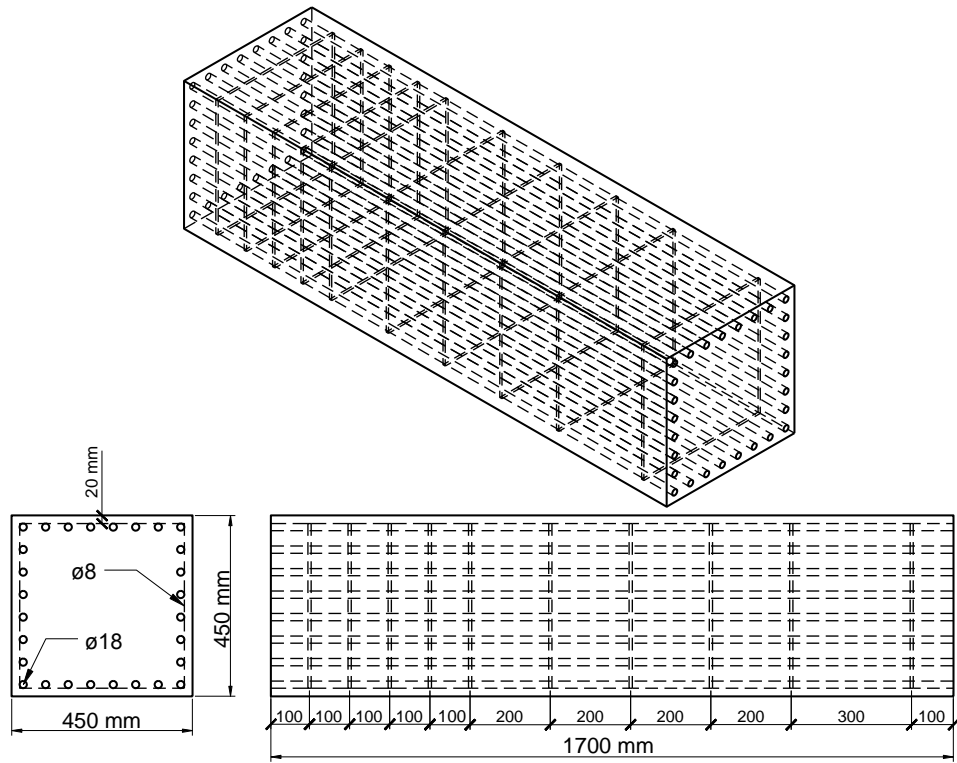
Kolon elemanı-1'in geometrisi ve donatı özellikleri.
